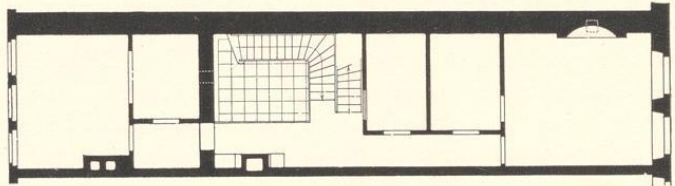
Grundriß des ersten Obergeschosses des Hauses Prinzipalmarkt 22
